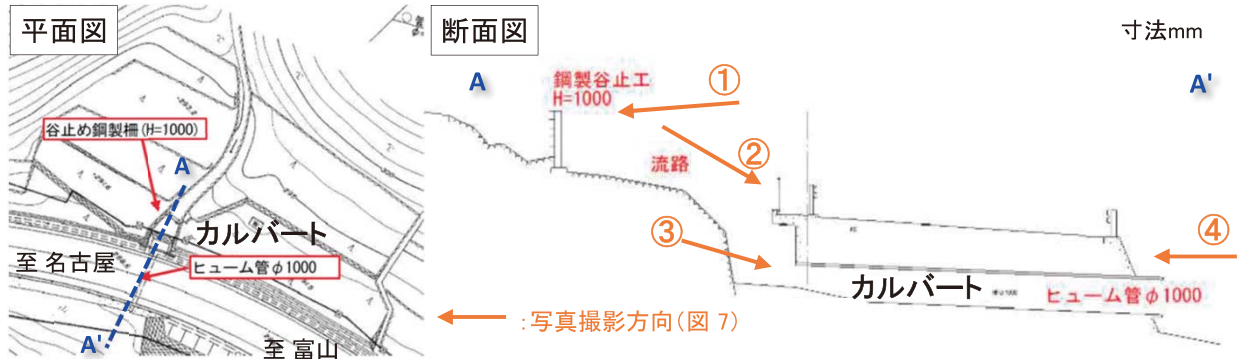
道路被害箇所周辺の被害発生当時の施設平面図及び断面図
